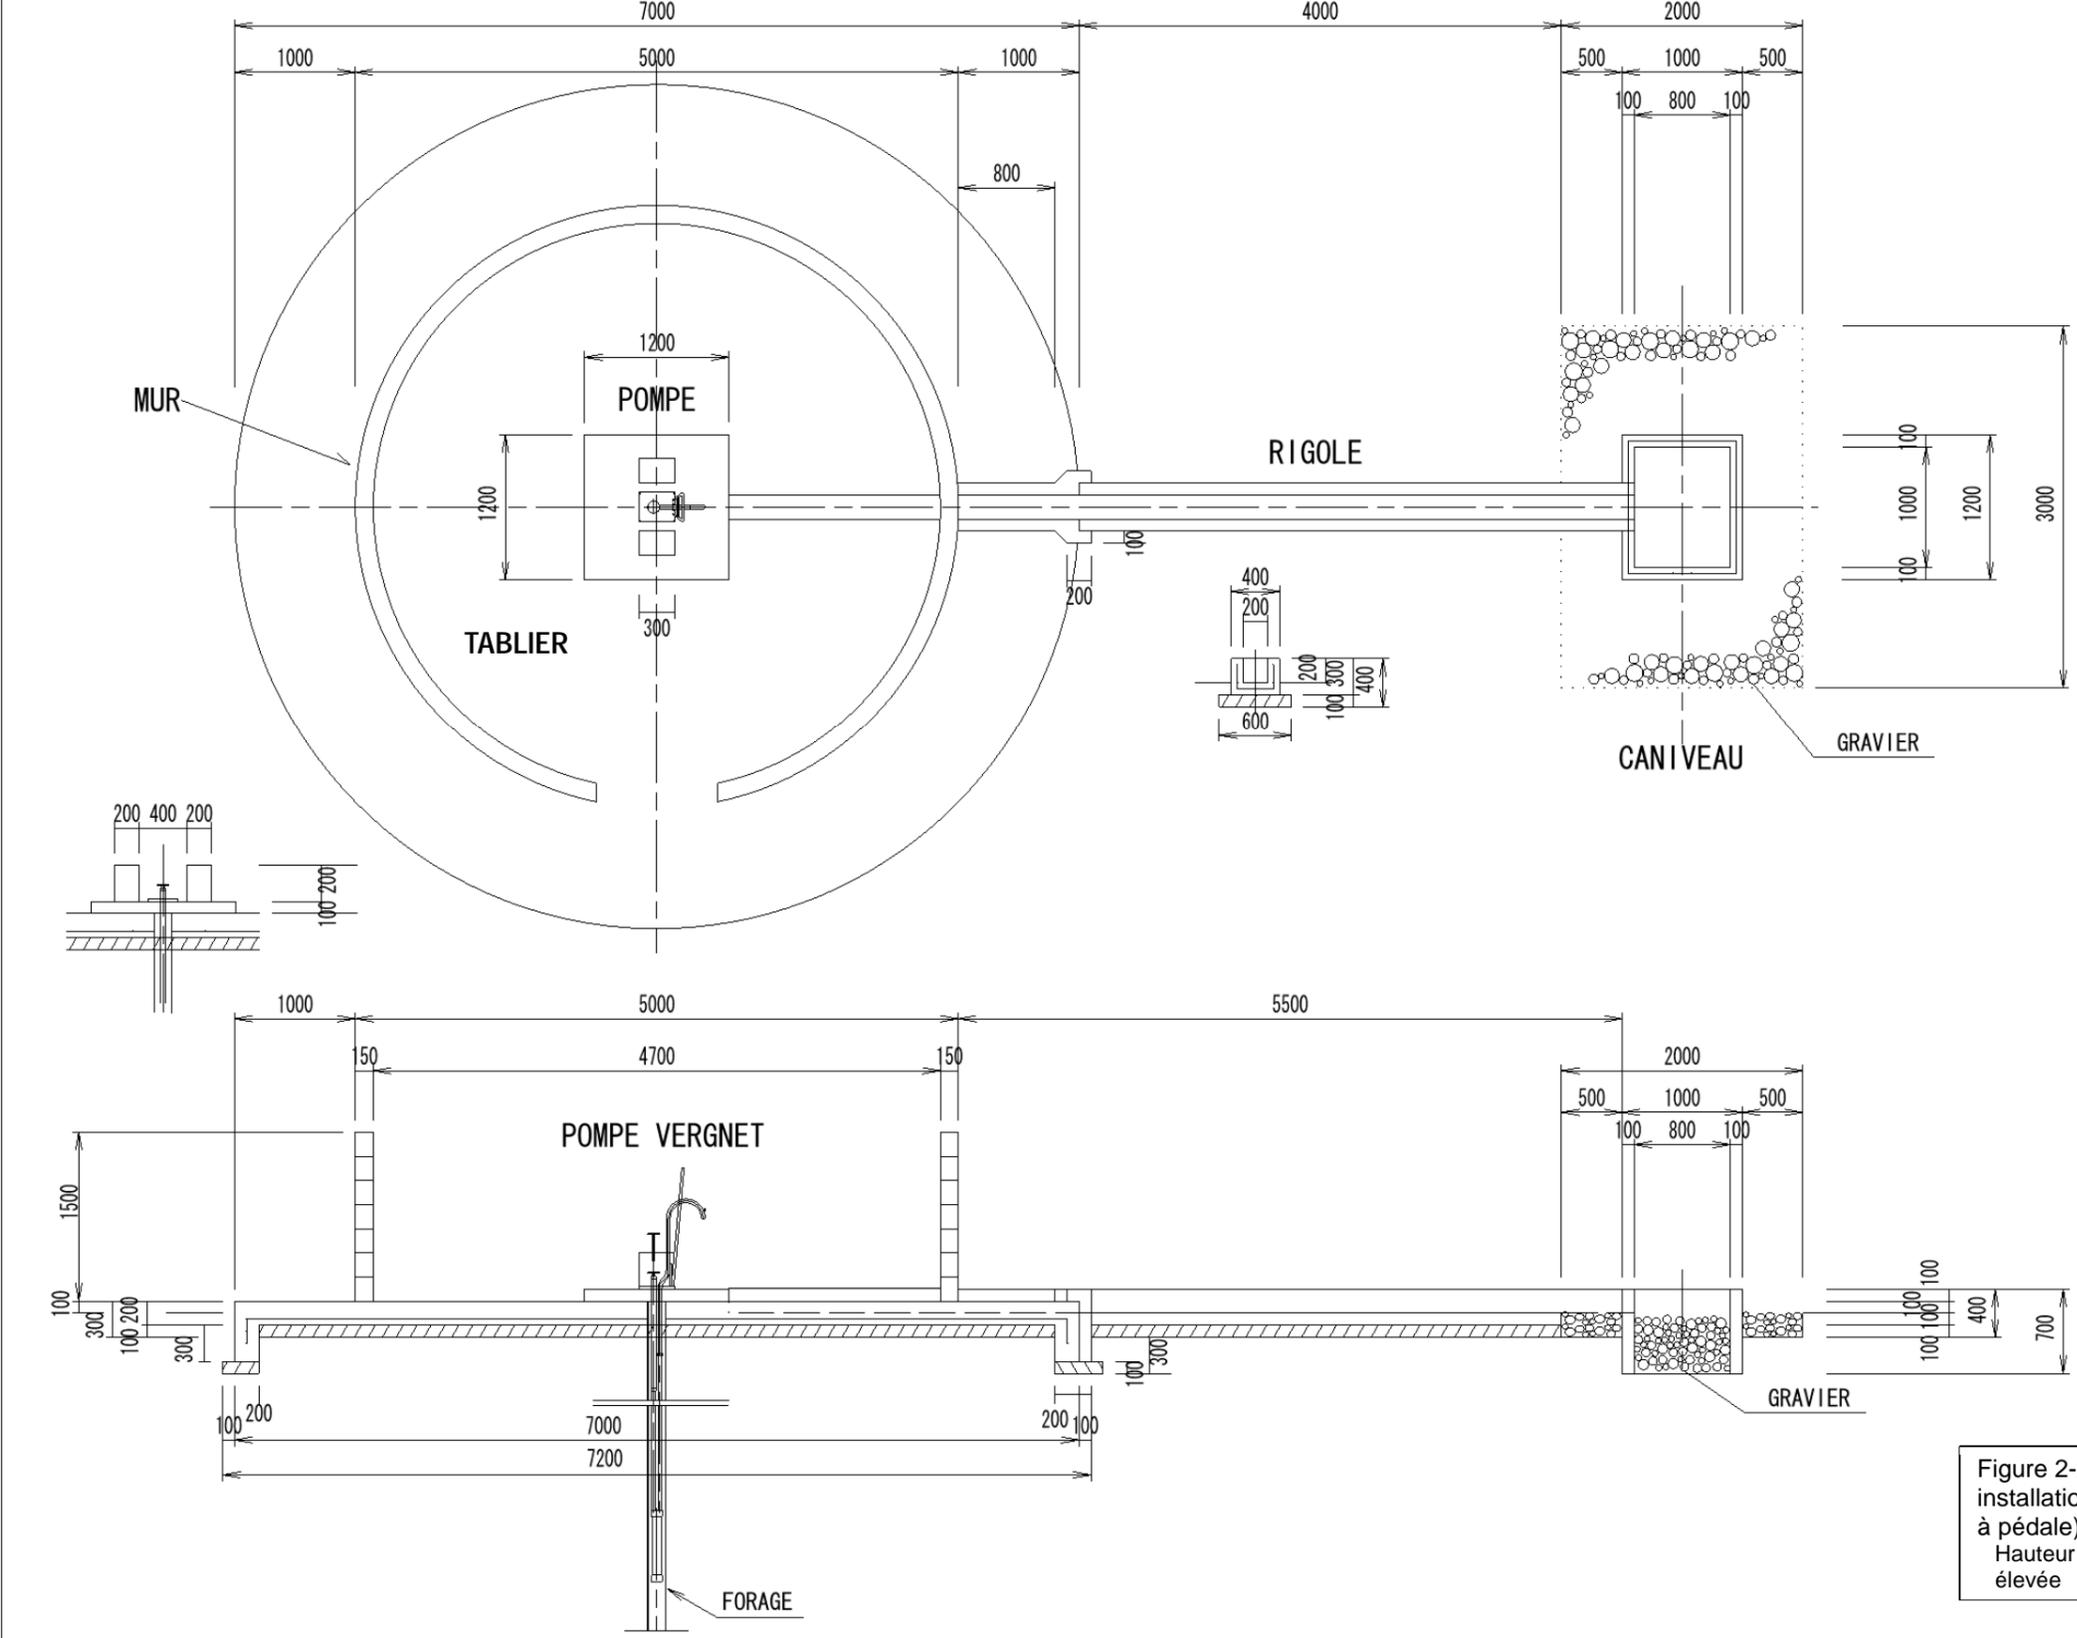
Plan des installations hydrauliques (pompe à pédale)
